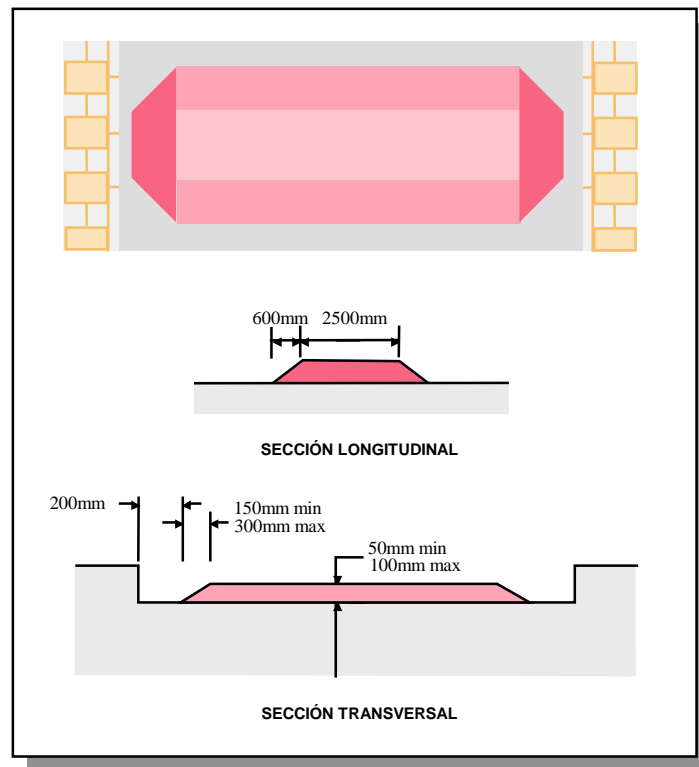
Policía acostado de perfil trapezoidal: planta, sección transversal y longitudinal.
